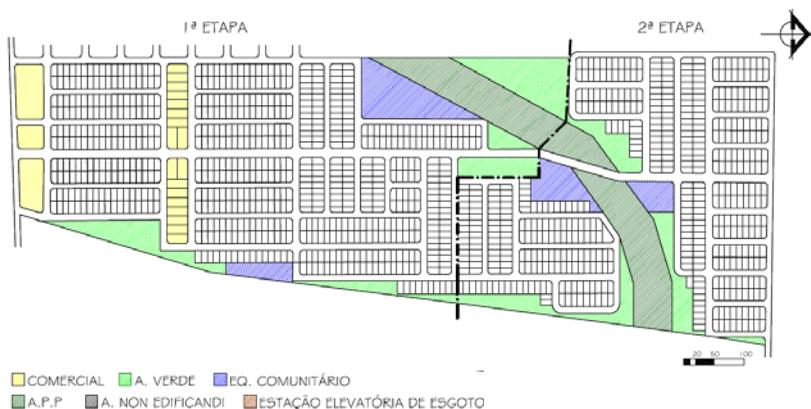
Conjunto Nova Canaã – Planta do Loteamento.
